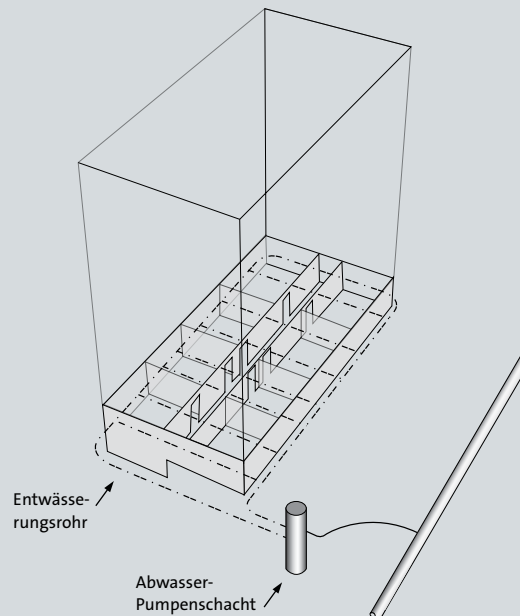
Drainagerohr um ein Gebäude mit Keller herum. Das Abwasser wird zum Pumpenschacht geführt
